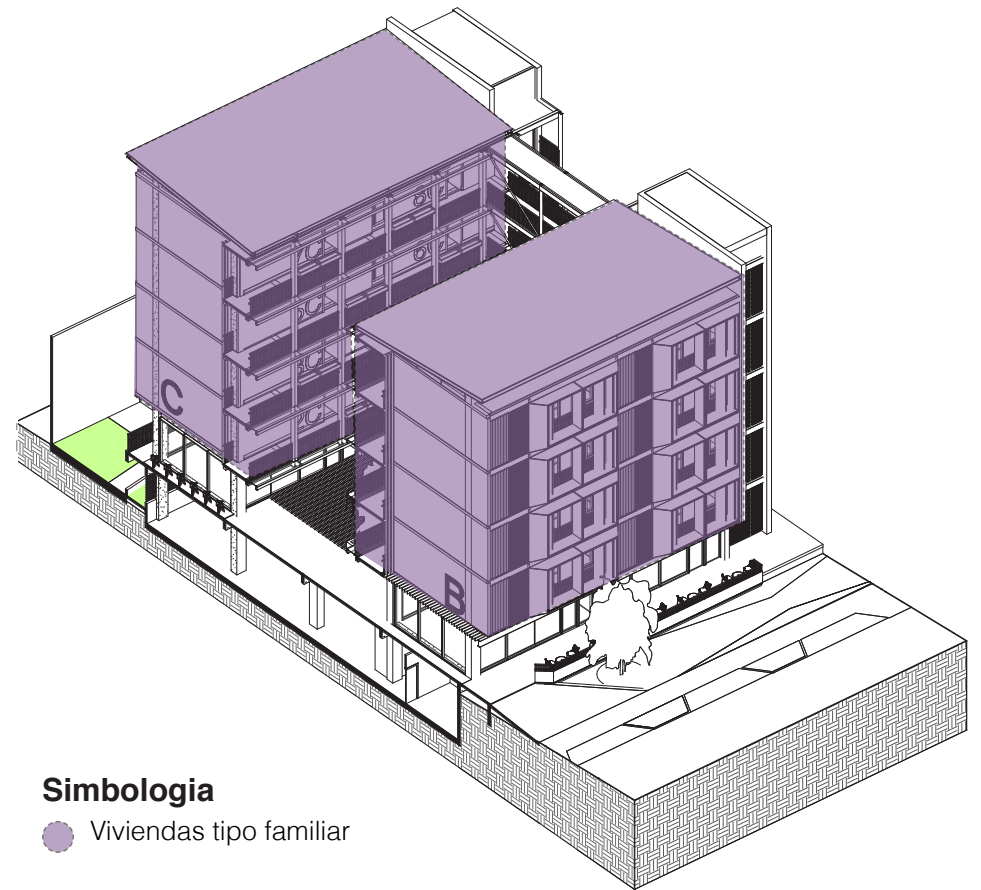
Planta típica de vivienda modulo B y C . Elaboración propia.
